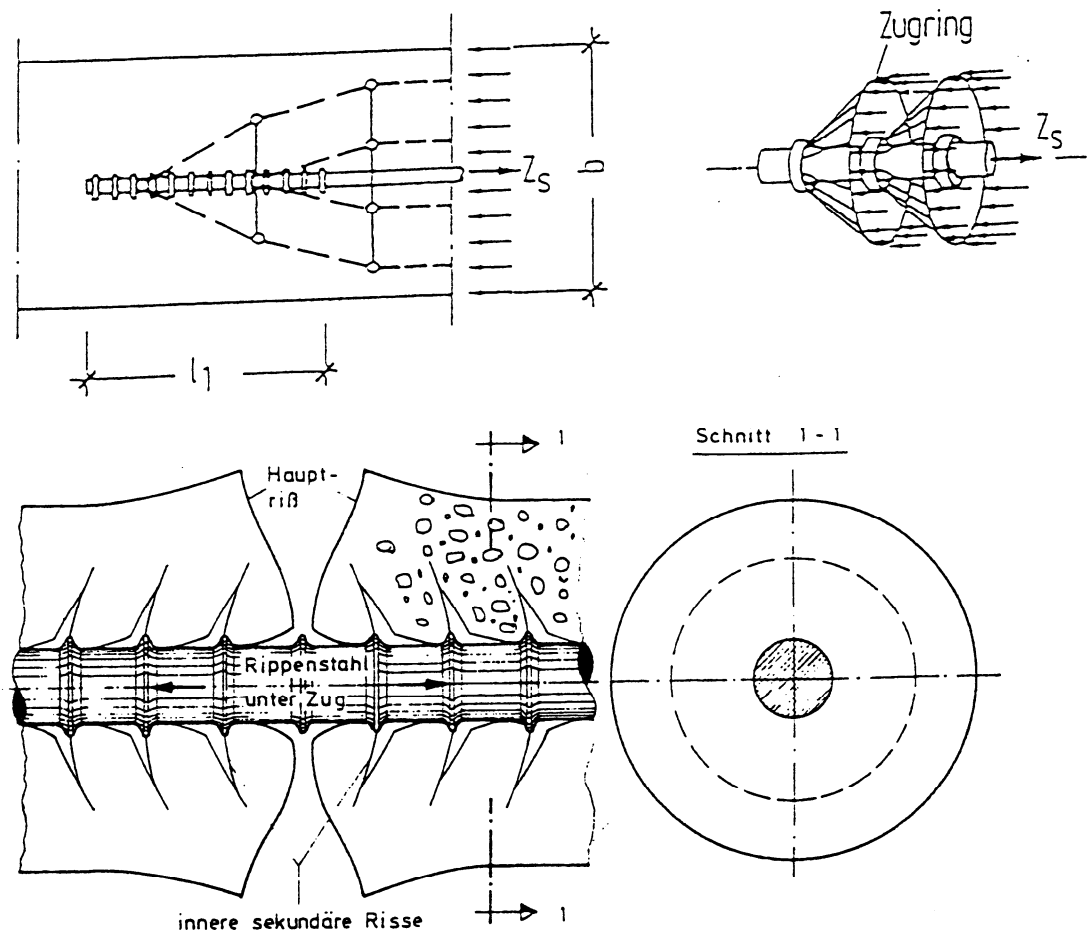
Tragmodell des Verbundes bei geripptem Bewehrungsstahl unter zentrischem Zug
